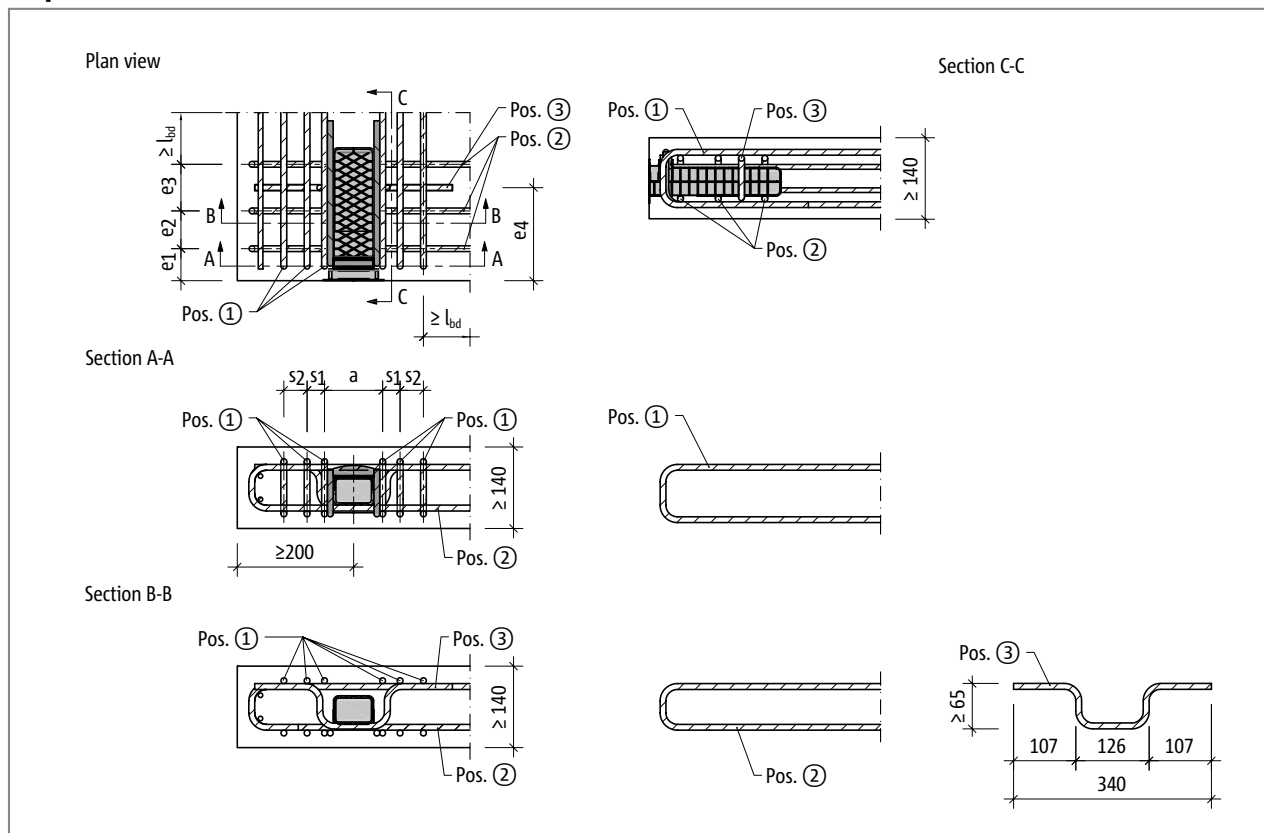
Schöck Tronsole® type Q: On-site reinforcement
